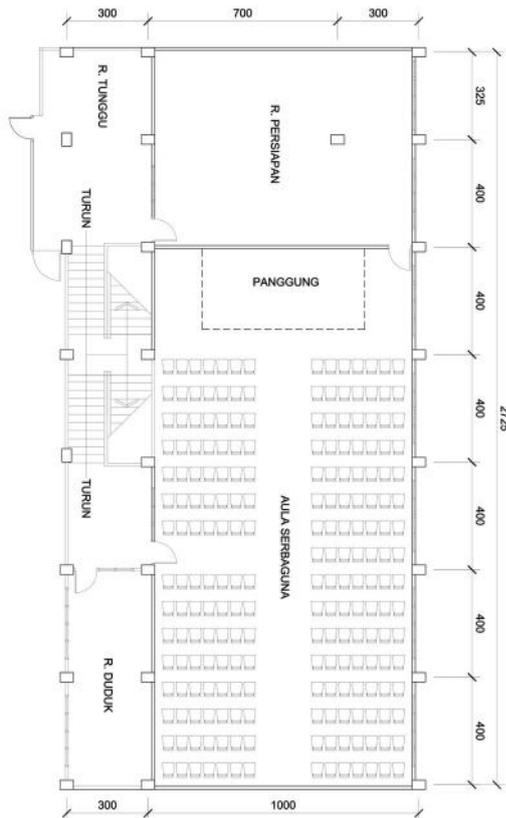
Denah kapasitas setelah pandemi covid-19 dengan layout classroom style
